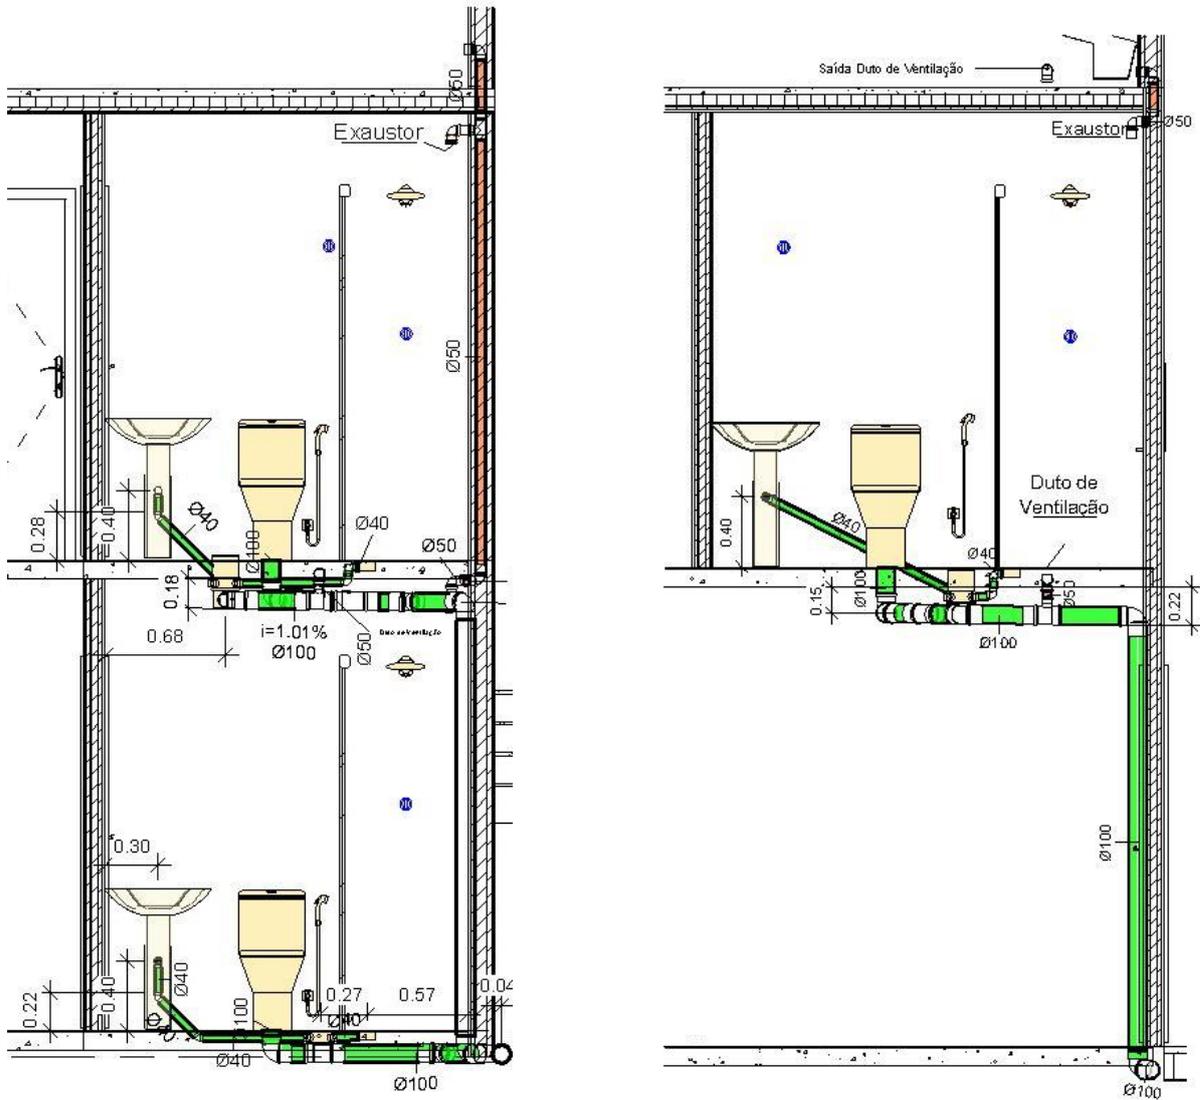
Esgoto sanitário Casas 1 e 4, banheiro 1º pavimento, desenvolvido pelo software Revit.
